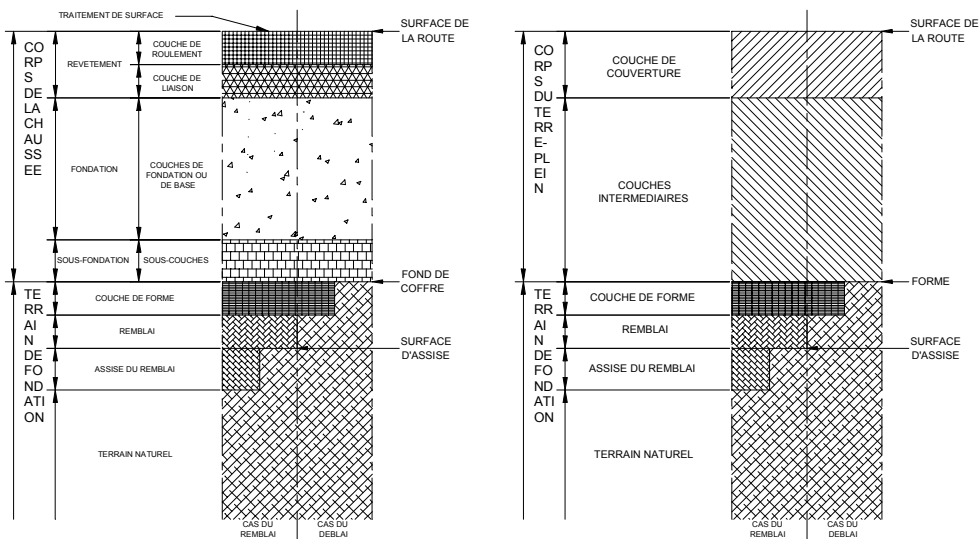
d : coupes dans la chaussée et le terre-plein
